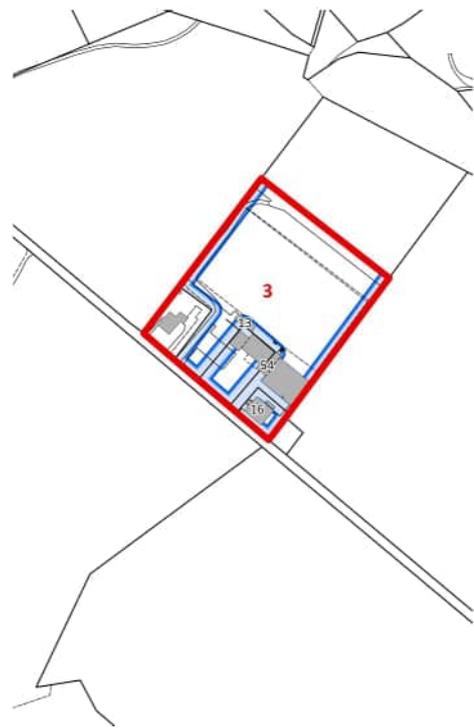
Gebäudelängen Schulhaus Ohmstal
